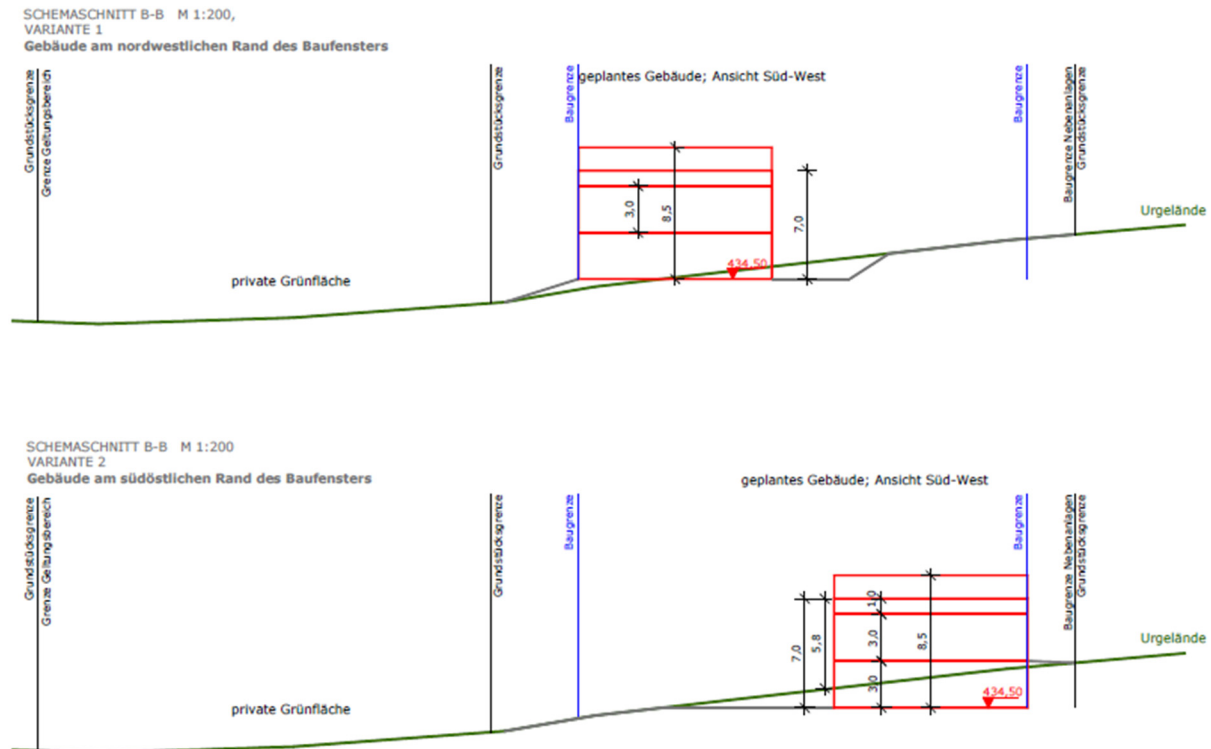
Schemaschnitte B - B, Geländeentwicklung mit möglichen Baukörpern;
